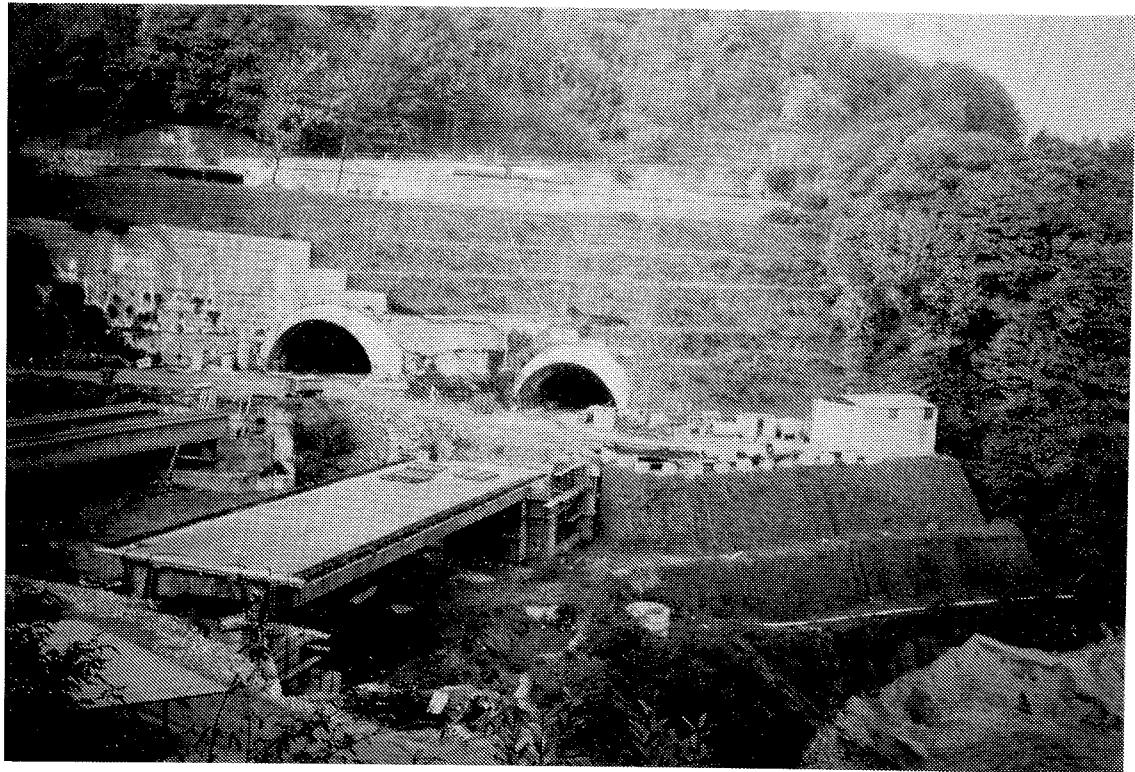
55 m høy armert jordkonstruksjon med vegetasjon i Stresa
